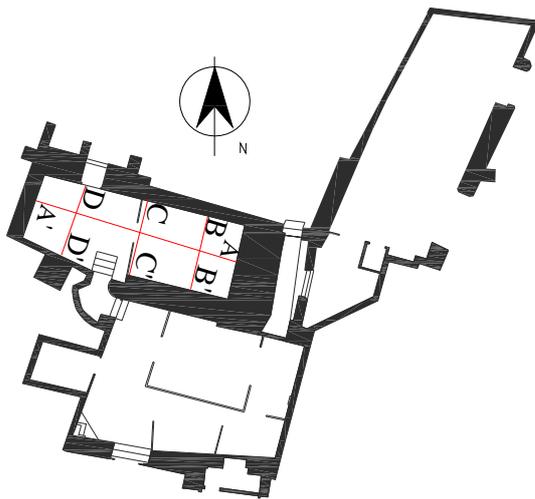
Plano situación de las secciones en la Habitación B.
